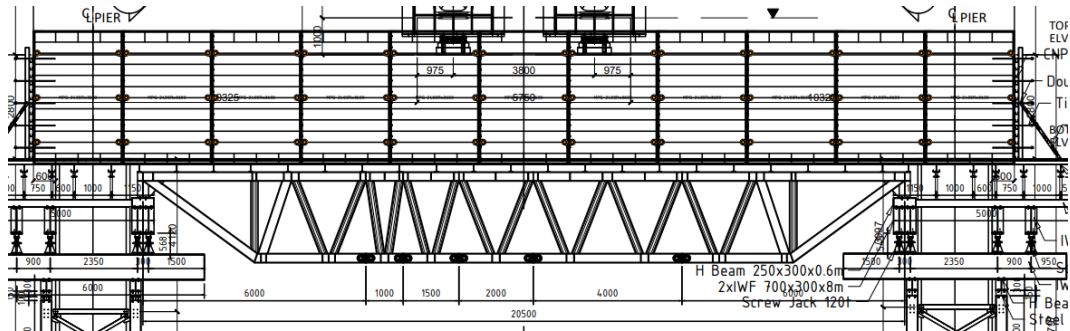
Model Struktur Rangka *Truss* pada SAP2000
